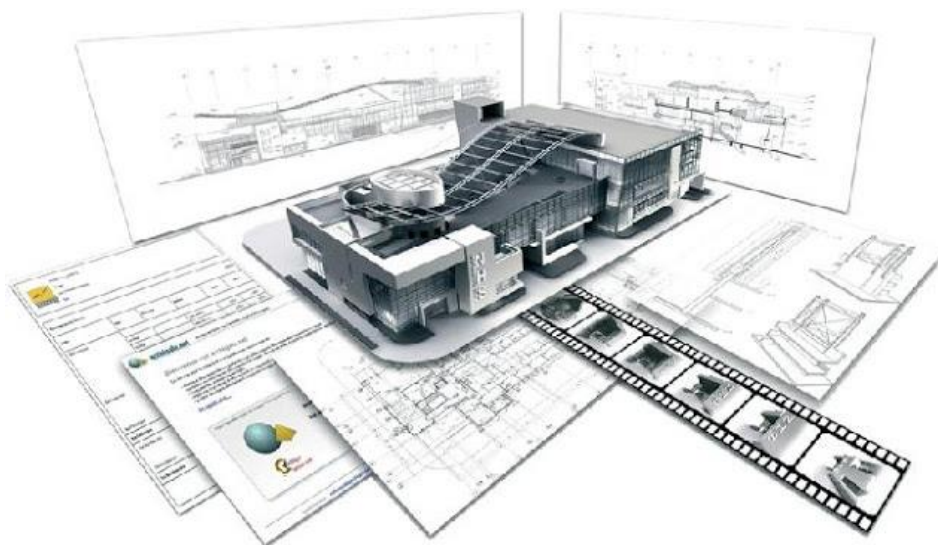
ภาพตัวอย่างของ building information modeling (BIM)
